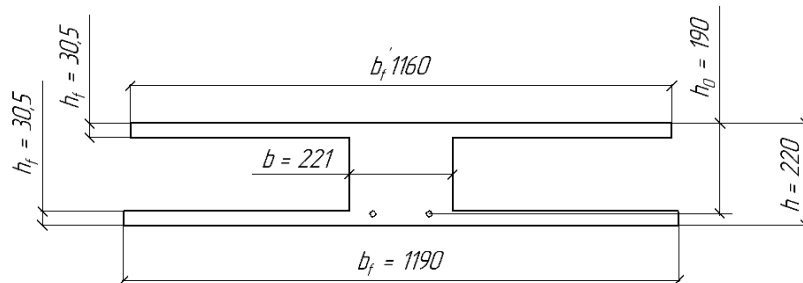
Сечение многопустотной панели перекрытия
